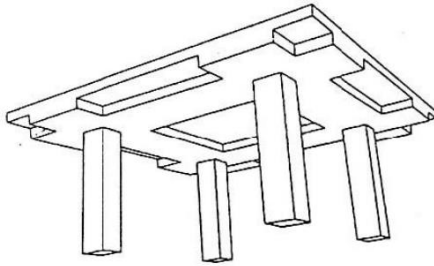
Losa de vigas planas en dos direcciones
